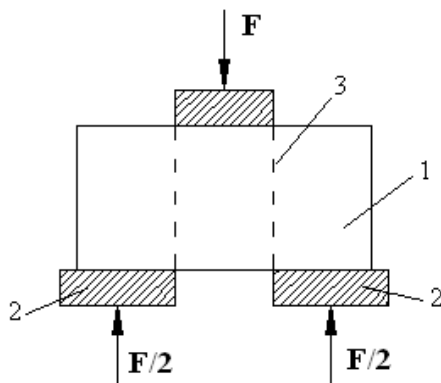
Схема випробування бетонного зразка на зріз: 1 - випробуваний зразок; 2 - нерухомі сталеві опори; 3 - площина зрізу
